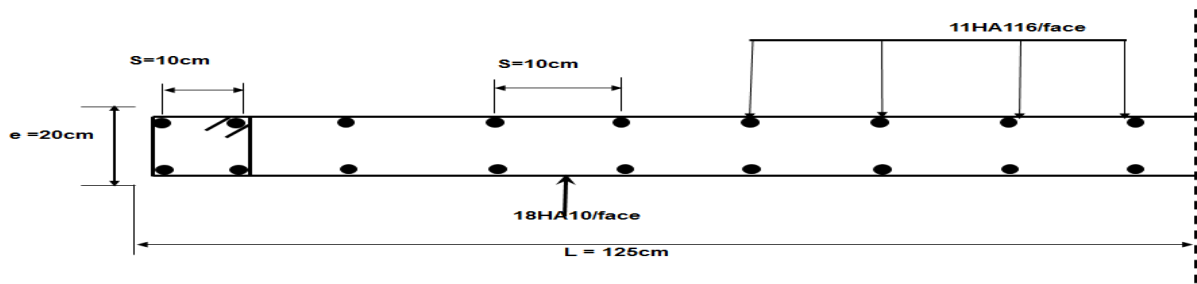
Schéma de ferrailage du voile V_{x1} au niveau du sous-sol
